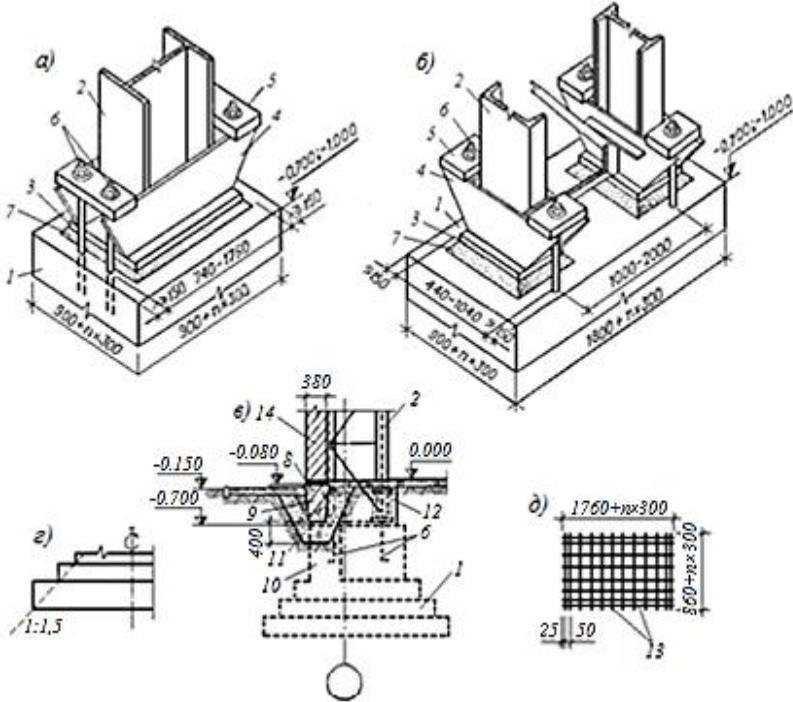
Монолітні залізобетонні фундаменти під сталеві колони, бази яких виконані у вигляді траверс: *а* – для колон суцільного перерізу; *б* – для двовіткових колон; *в* – з’єднання колони з фундаментом; *г* – до виносу ступенів фундаментної плити; *д* – арматурна сітка підколонника; *1* – залізобетонний фундамент; *2* – колона (вітки колон); *3* – опорна плита; *4* – траверса; *5* – анкерні плити; *6* – анкерні стержні (з гайками і шайбами); *7* – цементна підливка (цементний розчин 1:2); *8* – гідроізоляція; *9* – фундаментна балка; *10* – стовпчик; *11* – шлак; *12* – бетон; *13* – арматурна сітка; *14* – стіна
